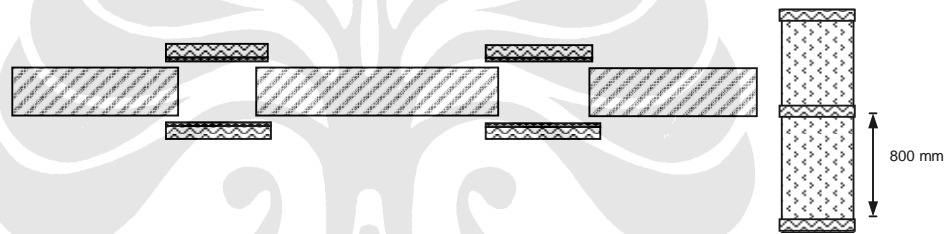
Bekisting cara tradisional elemen footing pondasi
